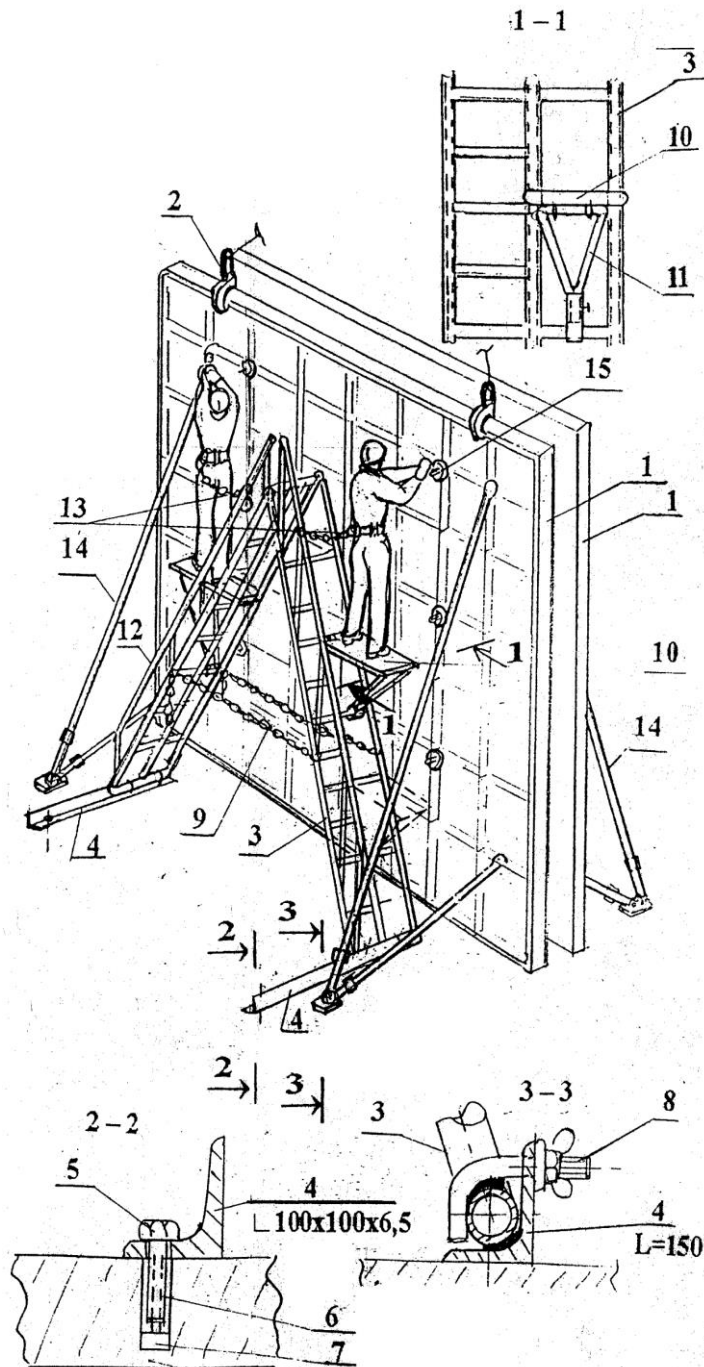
Схема транспортування та монтажу щитів вертикальної опалубки:
